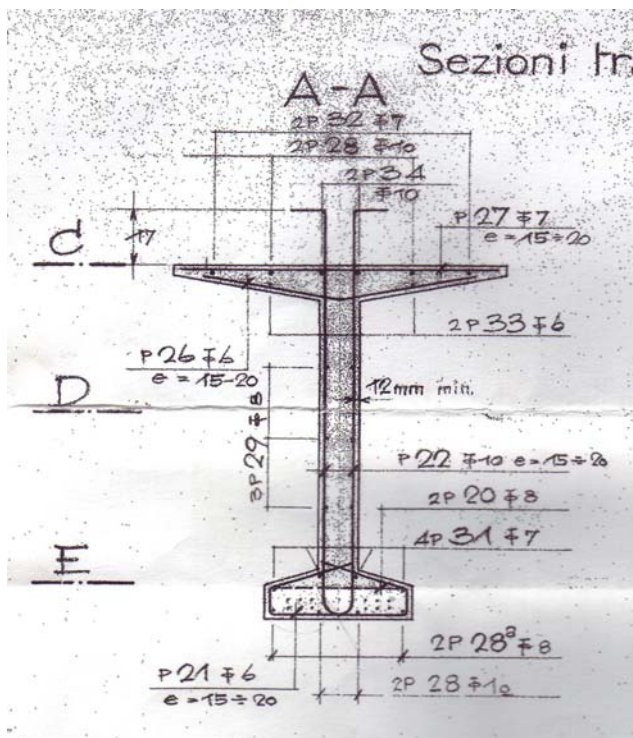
Planausschnitt mit Bewehrung des vorgefertigten Trägers
